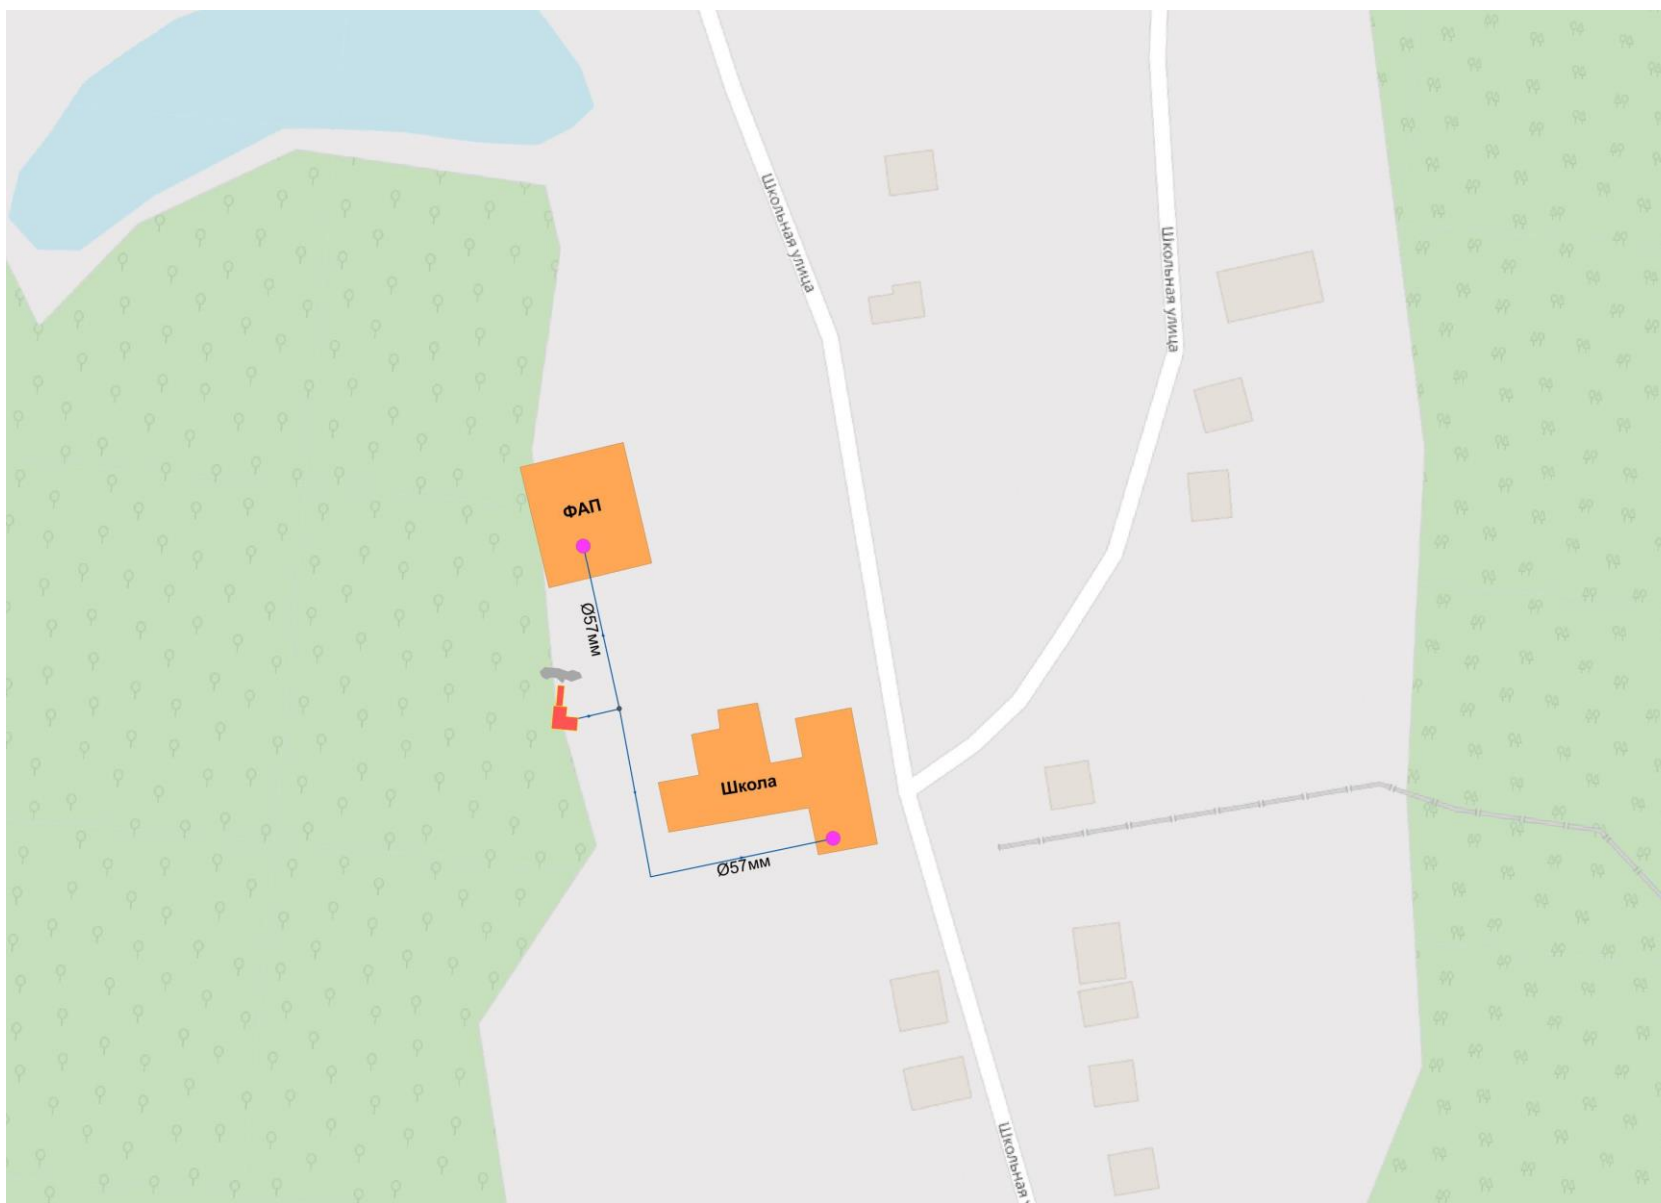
Схема теплоснабжения Котельной с. Крутые, ул. Школьная, д. 21
